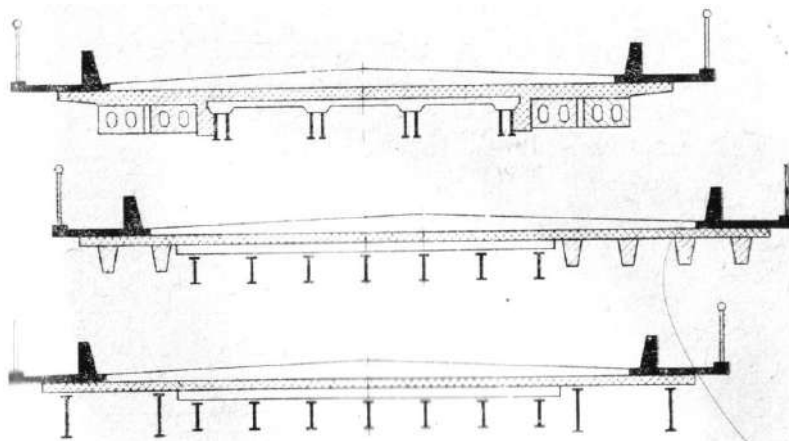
Способы уширения сталежелезобетонных пролетных строений с прокатными балками
